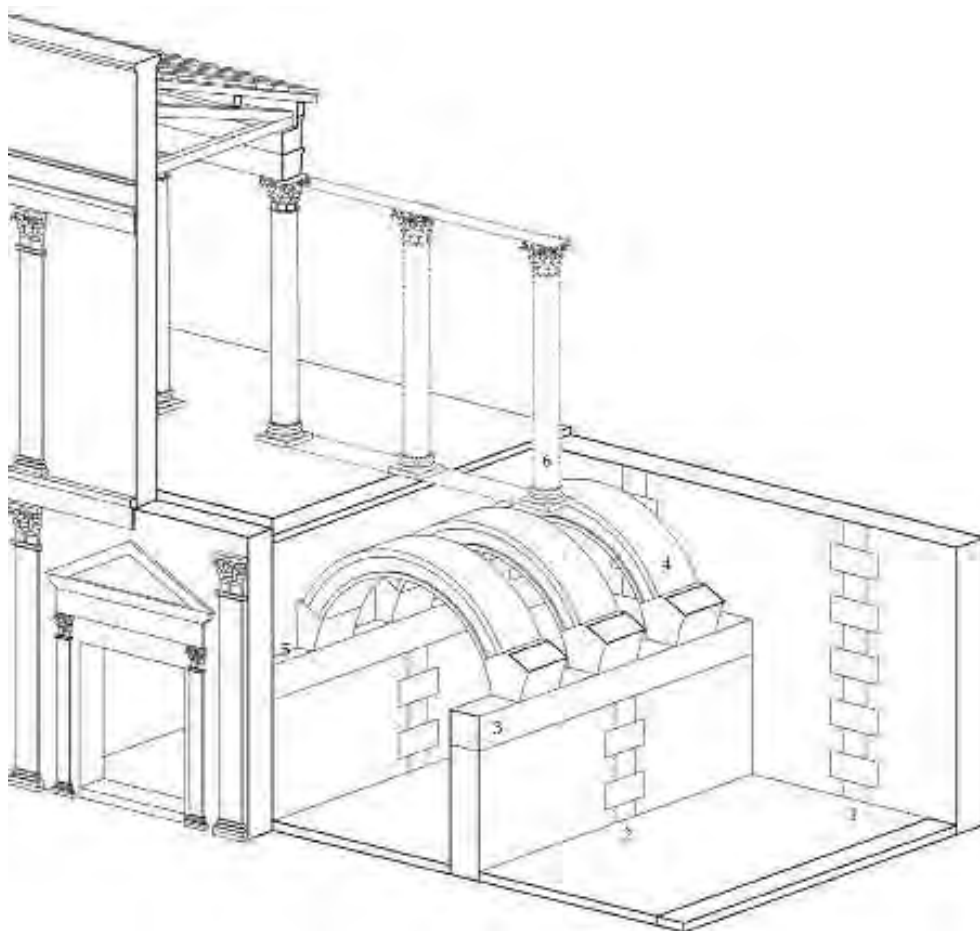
Sistema costruttivo delle *tabernae* della sostruzione e del portico soprastante: 1) pilastro dell'armatura del muro di terrazzamento; 2) pilastri dell'armatura dei muri divisorii fra le *tabernae*; 3) filari di coronamento in blocchi quadrati; 4) archi in cunei di pietra; 5) risega di appoggio della centina; 6) colonne del portico della piazza al livello superiore, in appiombio sull'arco al centro della volta della *taberna* sottostante.
